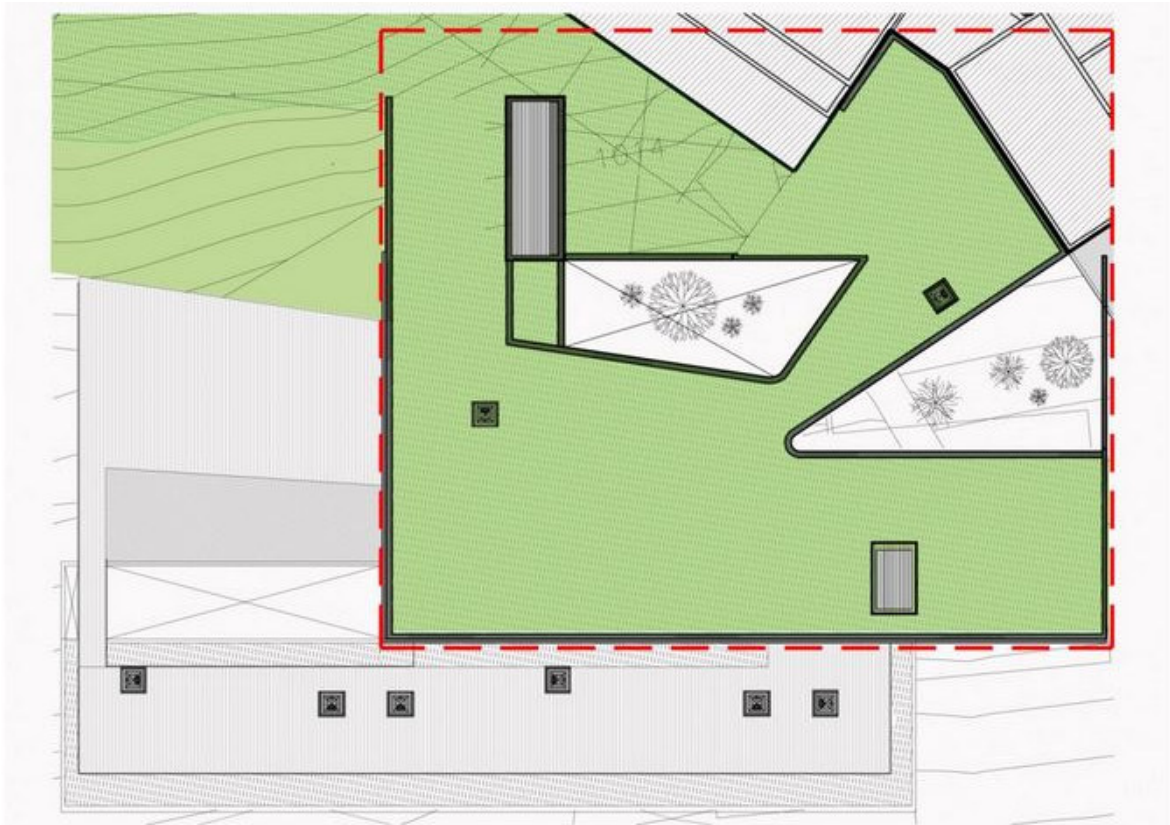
Planta baixa cobertura - esquema do pátio.
